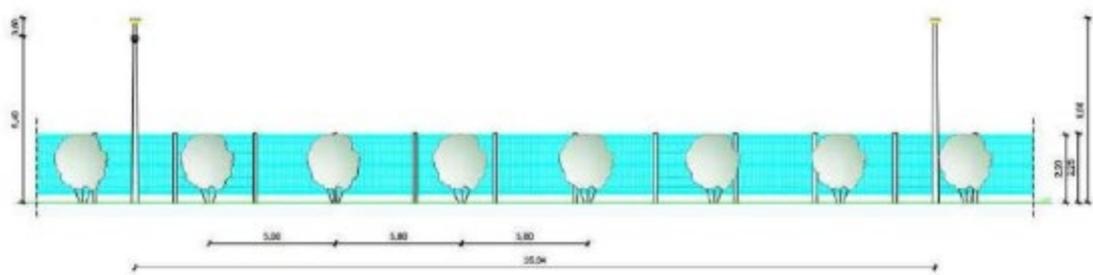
Prospetto frontale della prima fila di piante di alloro della siepe di mitigazione perimetrale
